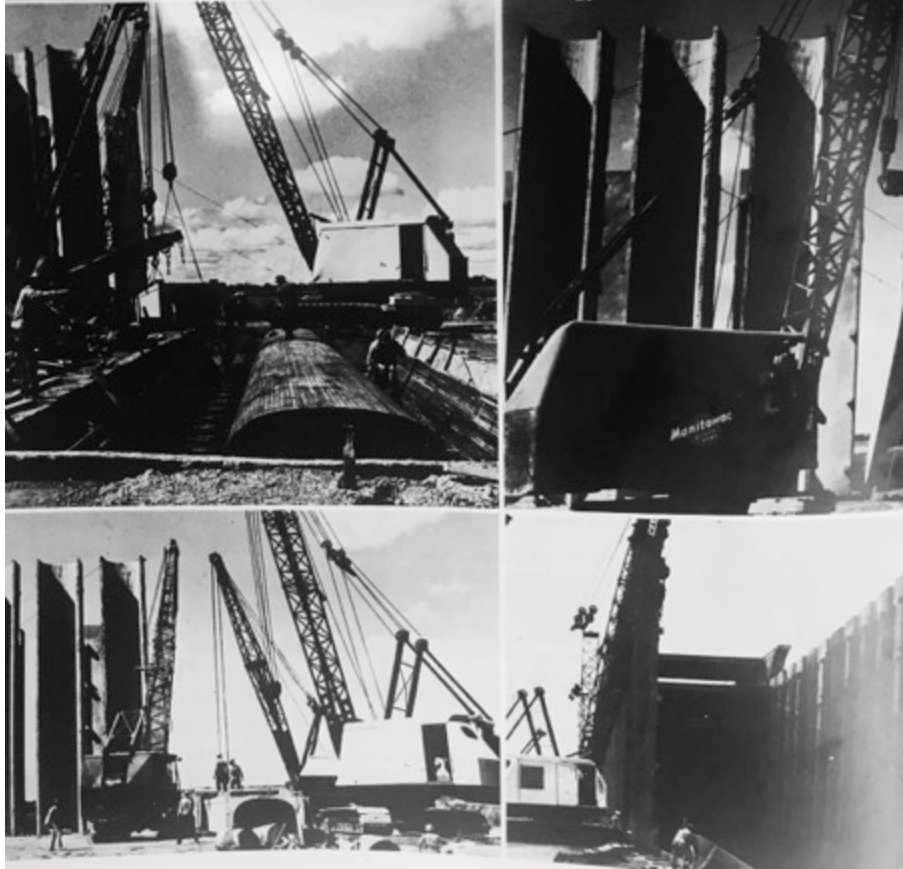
Fabricação e Locação dos pilares. Fonte: L'Architecture d'Aujourd'hui n.171, Janvier/Fevrier, 1974.
